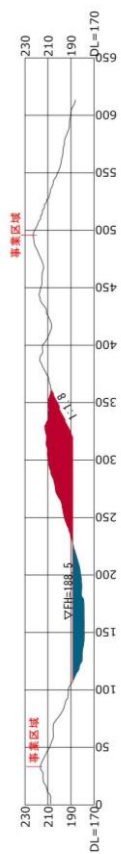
(3) 切土・盛土計画断面図 (E3-E3' 断面)
